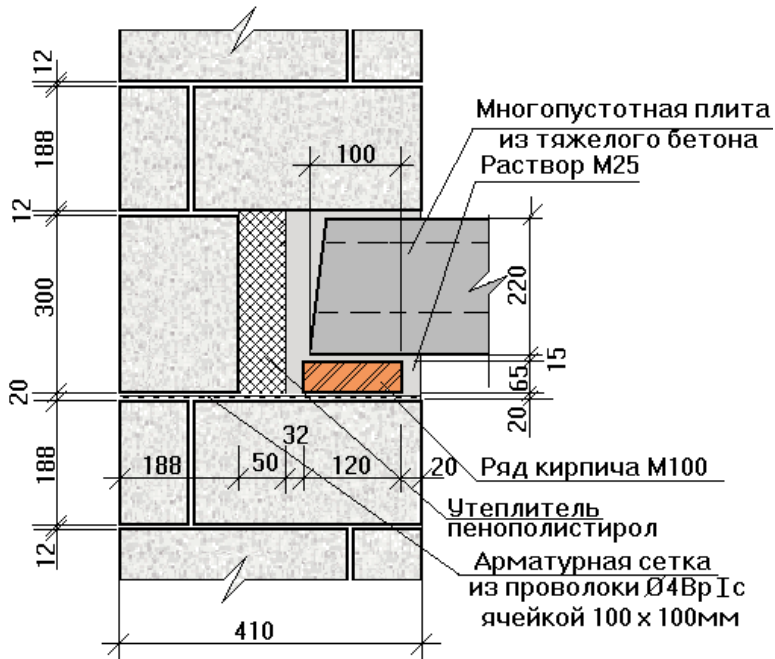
Пример опирания железобетонной плиты перекрытия на стену толщиной 410мм.
